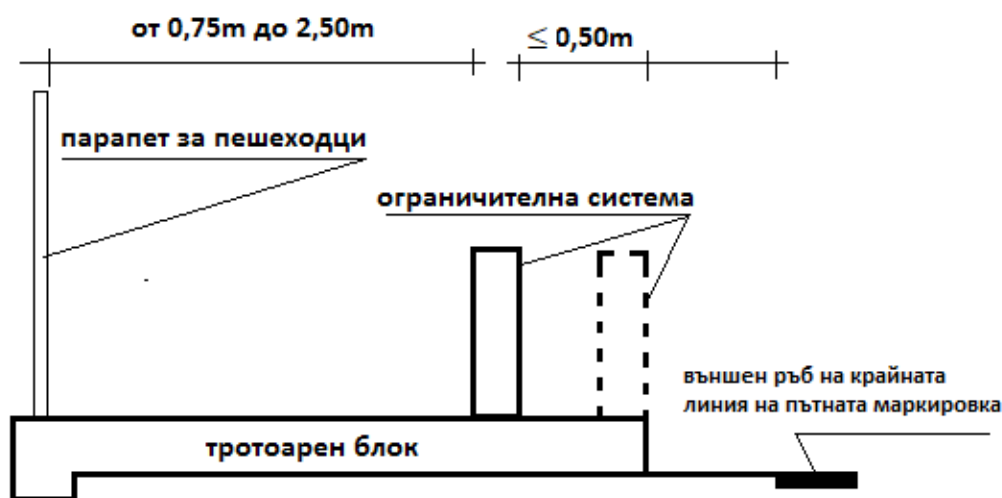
Emplacement d'un dispositif de retenue sur un bloc de trottoir de l'installation
